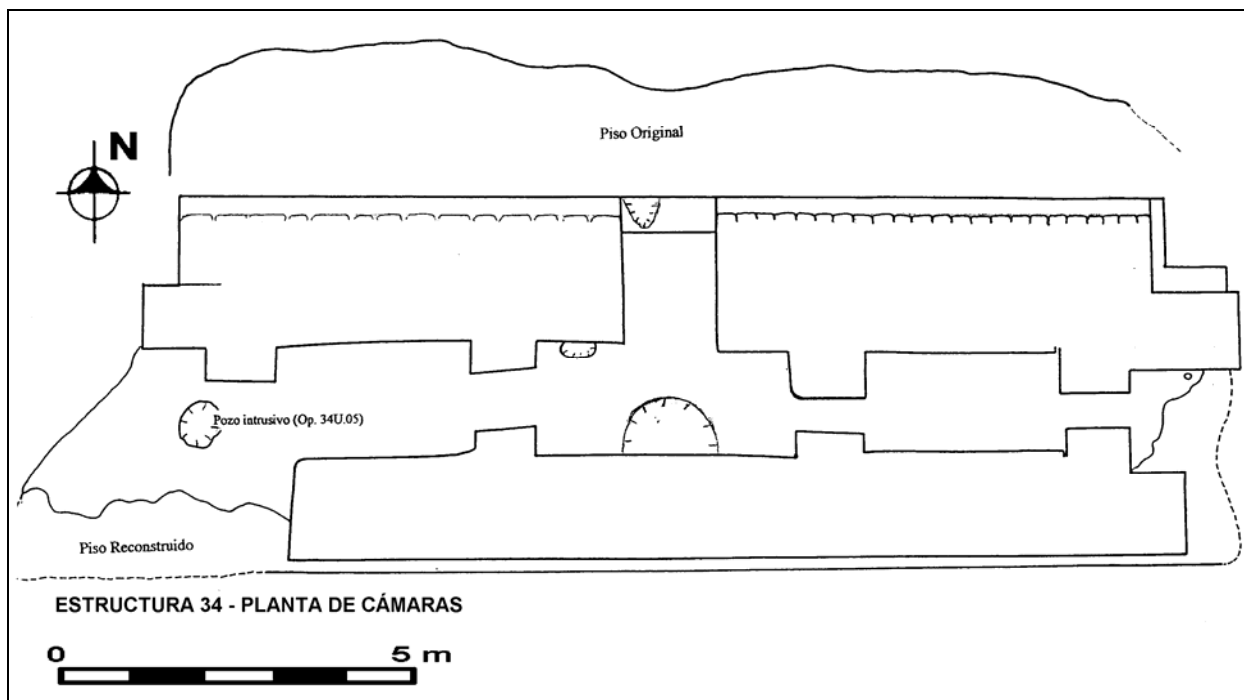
Planta final de cámaras, Estructura 34 (Dibujo A. Linares)
